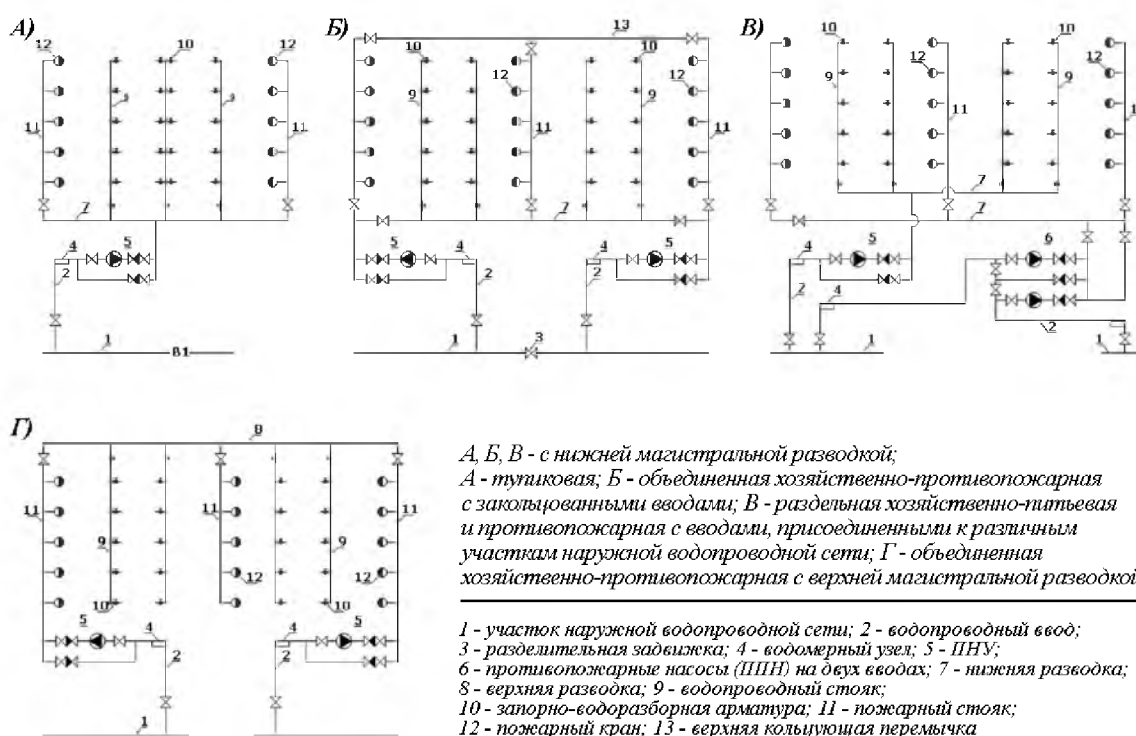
Схемы однозонных внутренних водопроводов зданий с ПНУ
